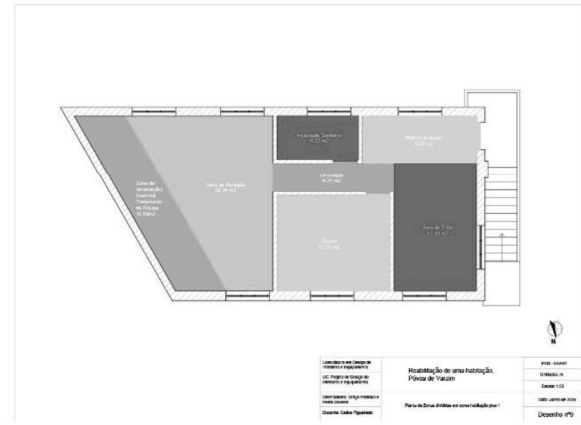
Planta de Zonas Habitação Piso 1. Fonte: Autor.
